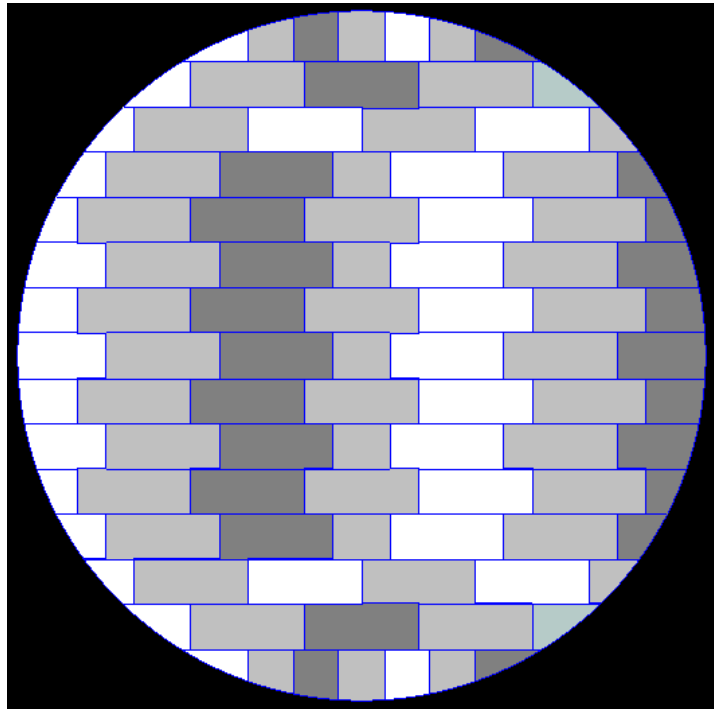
Vista en planta del arreglo de las placas de techo.
